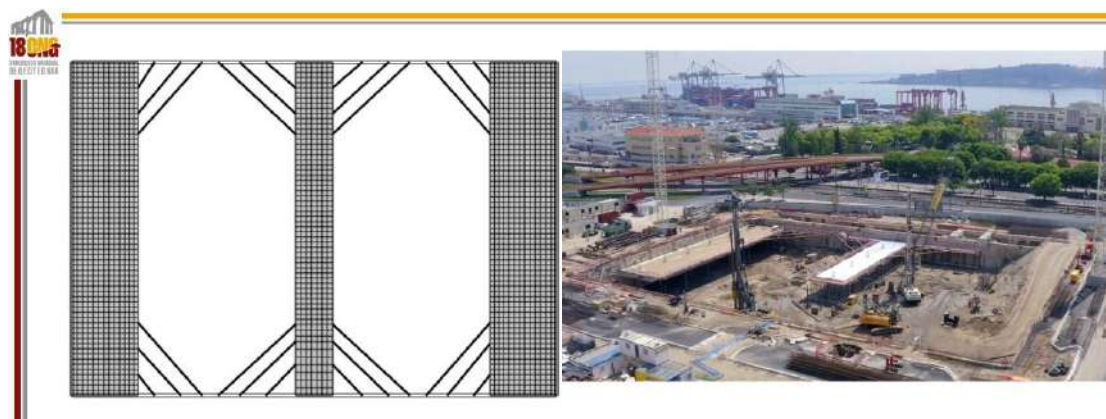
Modelo de Cálculo e construção das Bandas de Laje
